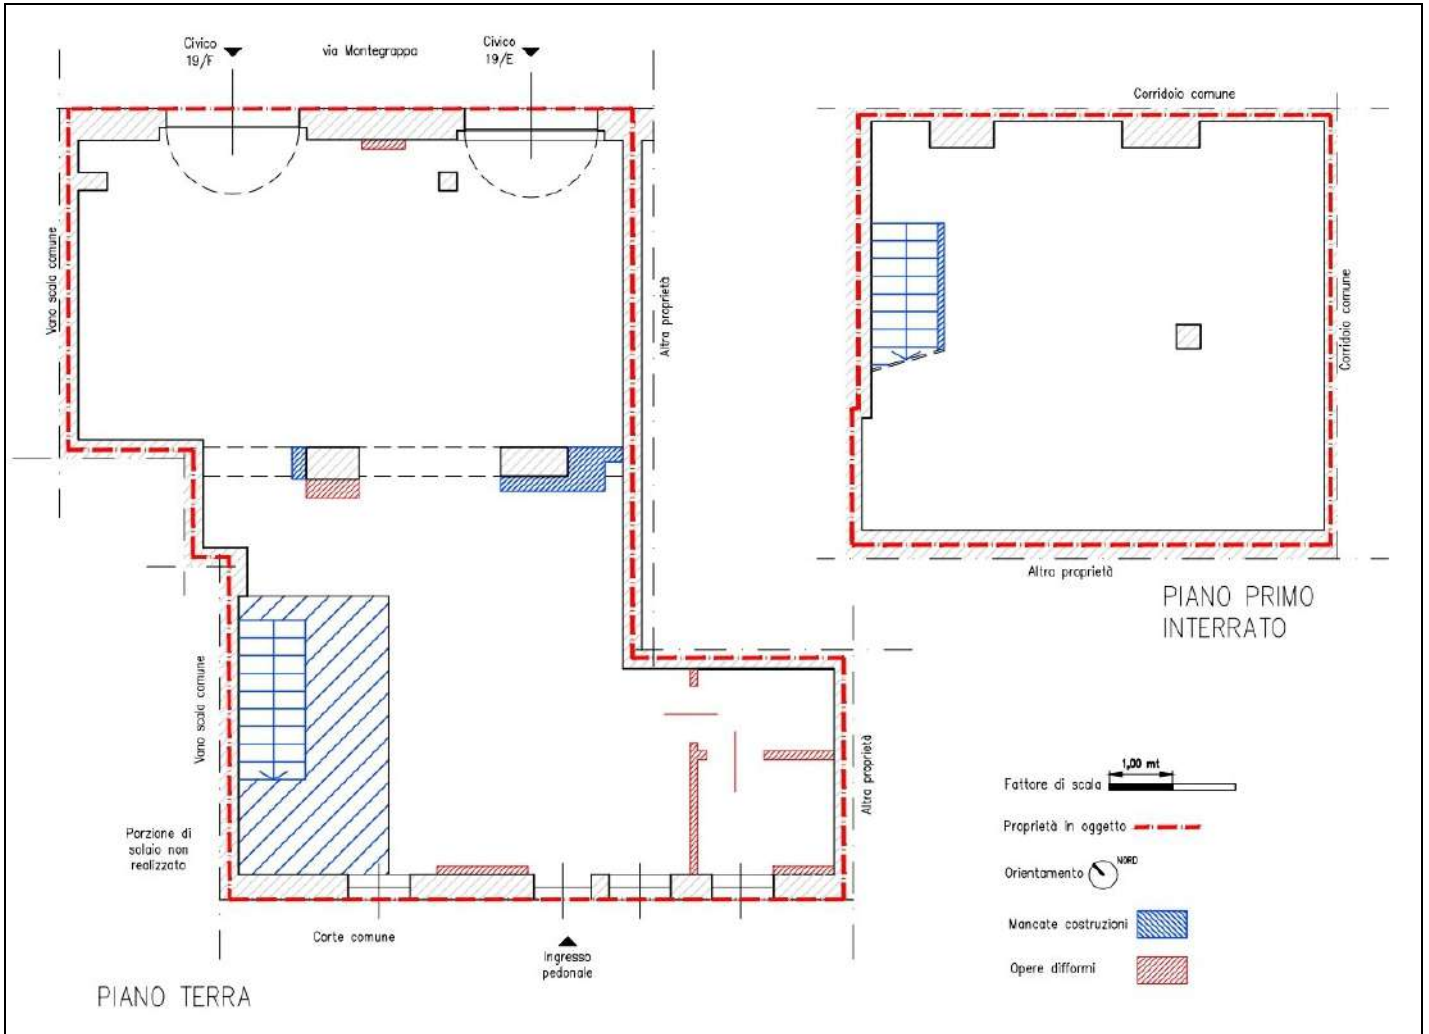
Pianta di confronto tra rilievo e planimetria catastale ultima in atti
